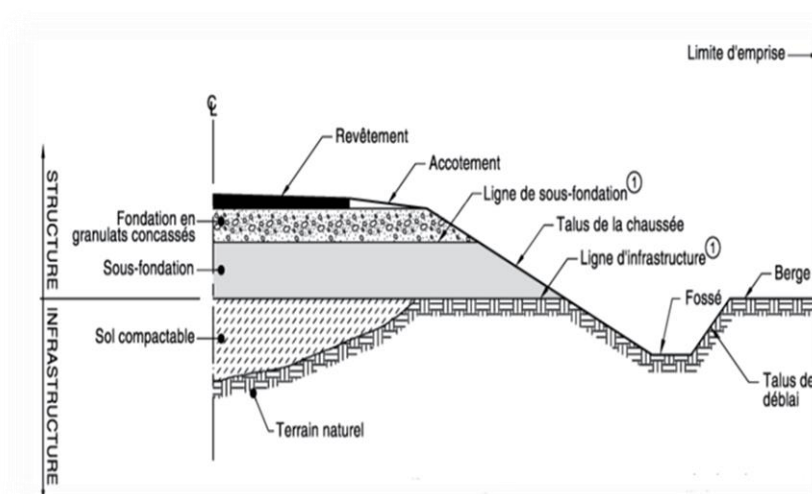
Structure conventionnelle d'une chaussée revêtue (MTQ)
